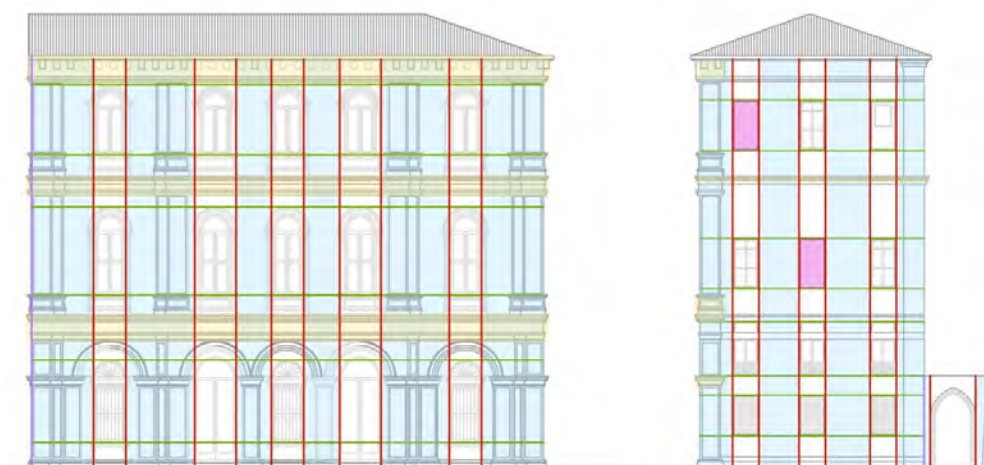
Prospetto Nord e Prospetto Ovest
